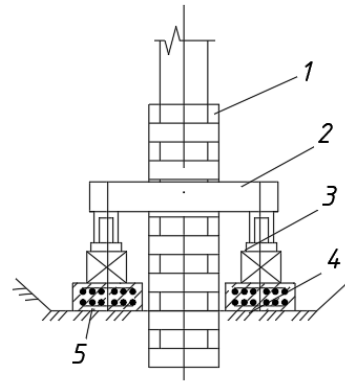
Підсилення стрічкового фундаменту підведенням:
